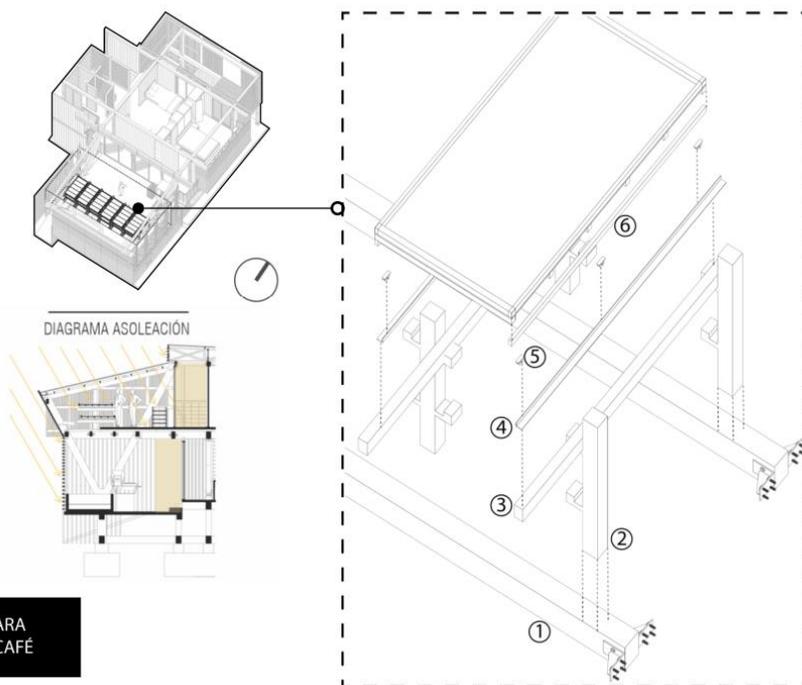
Planimetría: Zona I Nivel II. Elaboración propia.
